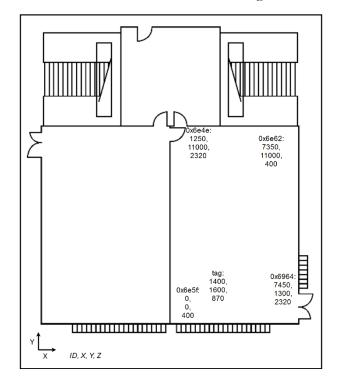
Grundriss des HSR Labors mit den Antennen des Positionierungssystems
